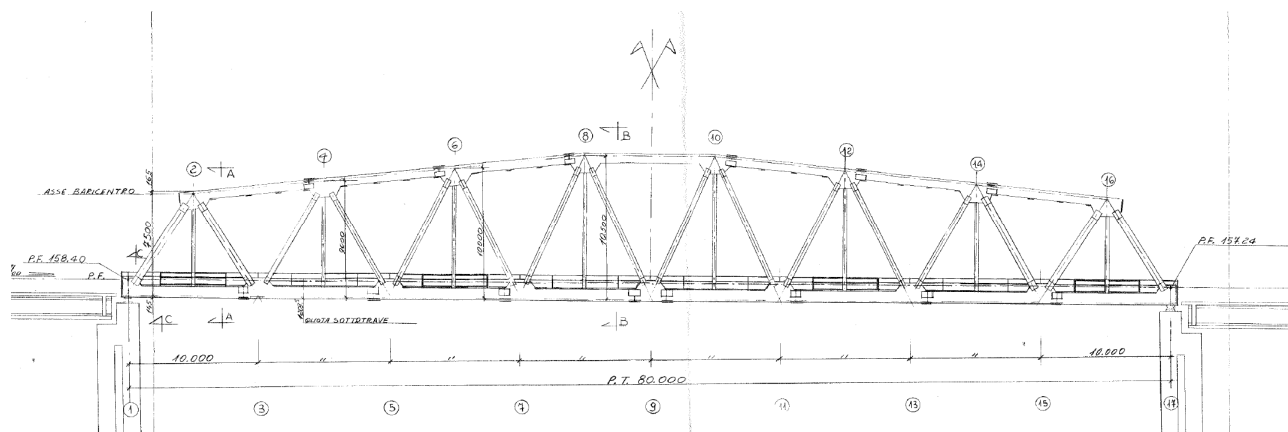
Prospetto longitudinale campata reticolare acciaio
